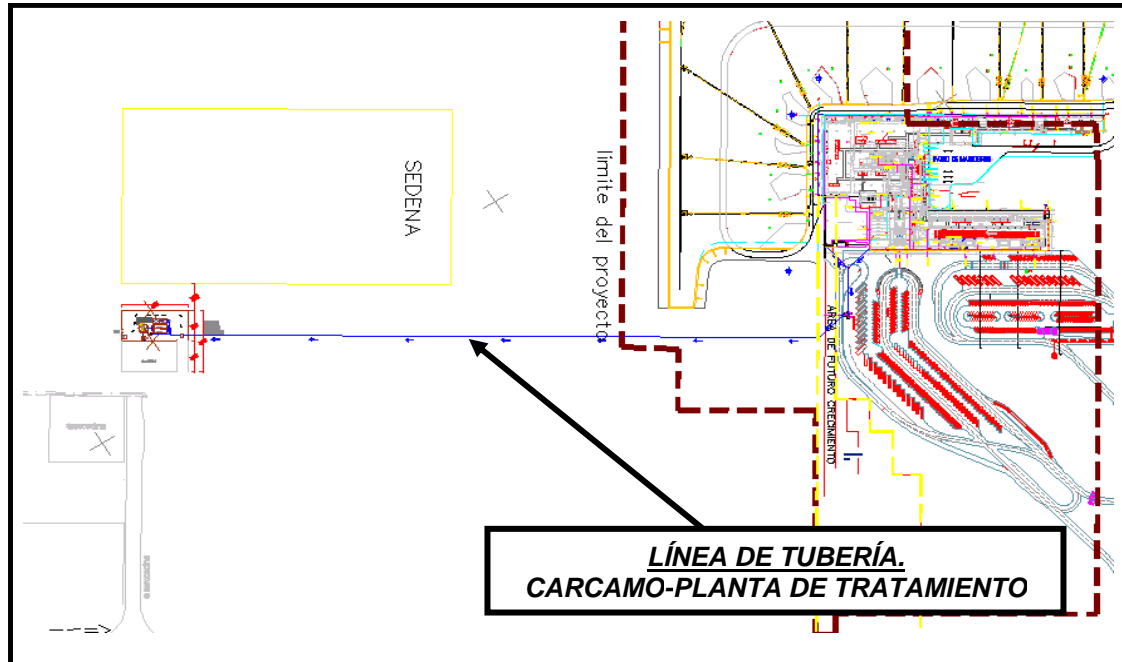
Trayecto del sistema de conducción de la planta de tratamiento.
